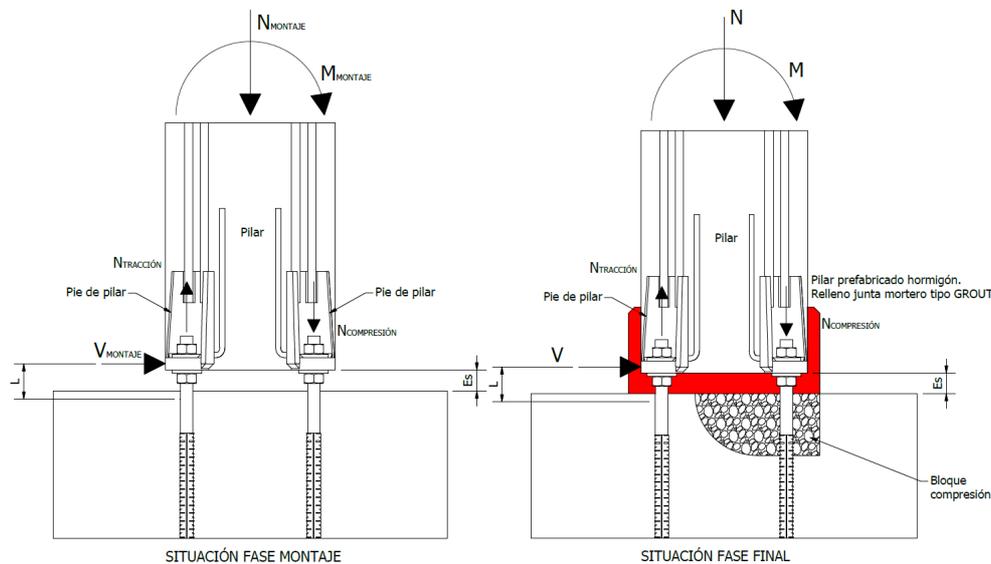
Acciones sobre el pilar en situación de montaje y final
